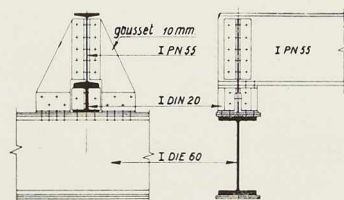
Détail d'assemblage des poutres de 14 mètres portant la coupole translucide.
